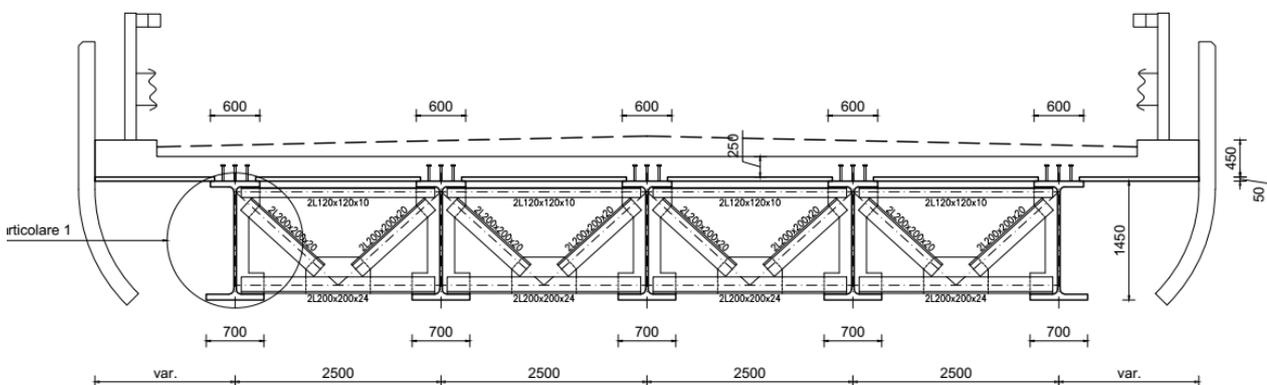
Sezione Strutturale Tipo del Viadotto Collestrada
